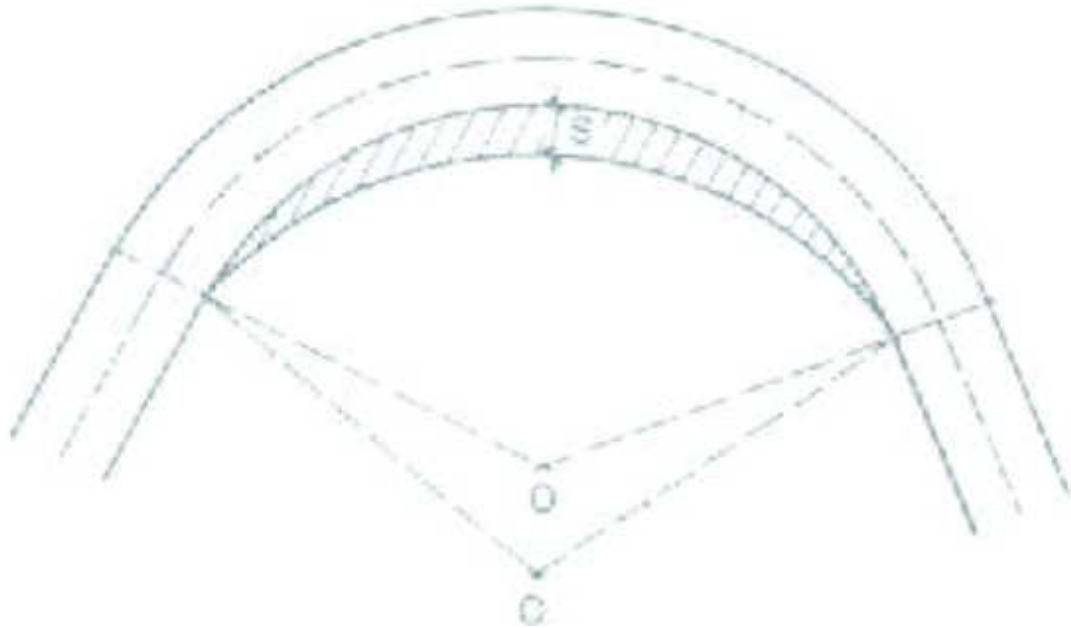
Sobreeancho. (Libro Caminos rurales Proyecto y construcción de Rafael Dal-Ré)
